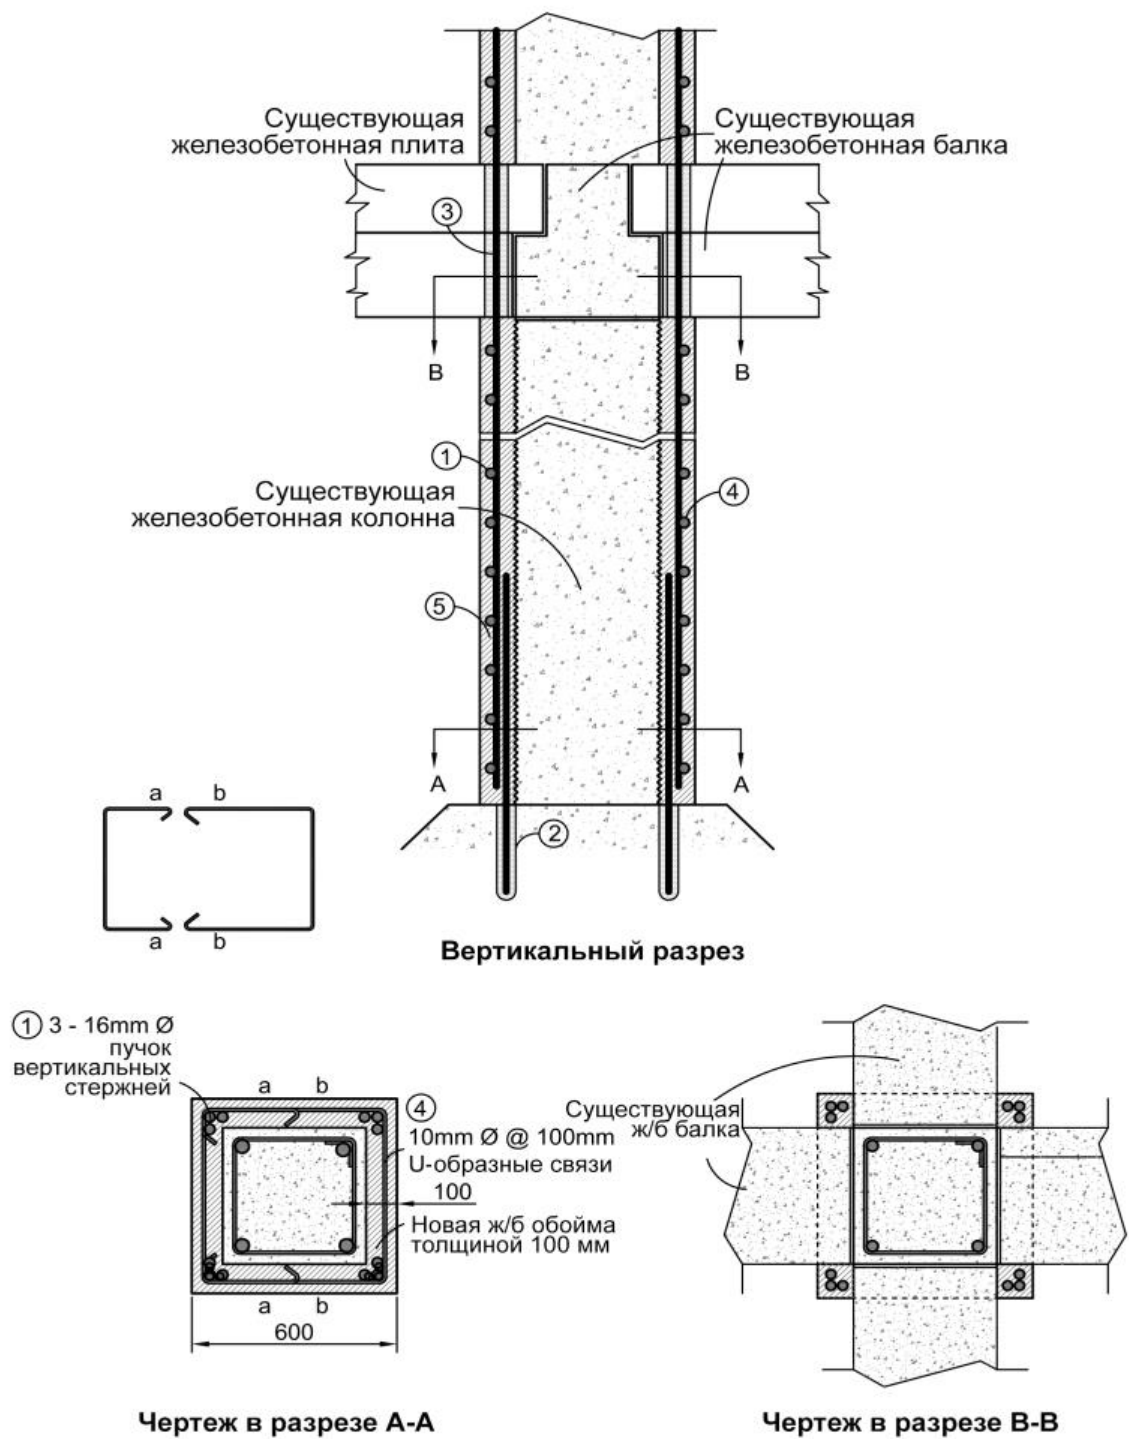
Схема сейсмоусиления колонны с железобетонным обрамлением:
